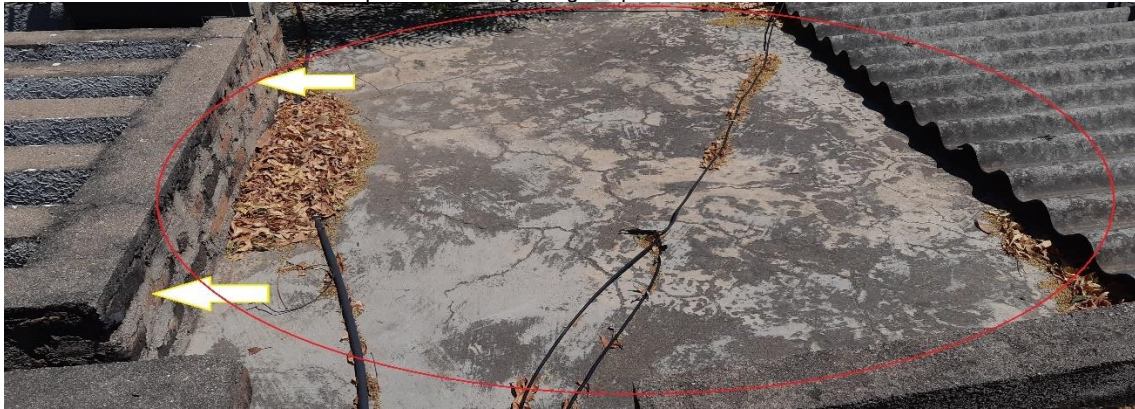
Presencia de fisura y agrietamiento, se requiere demolición completa.
